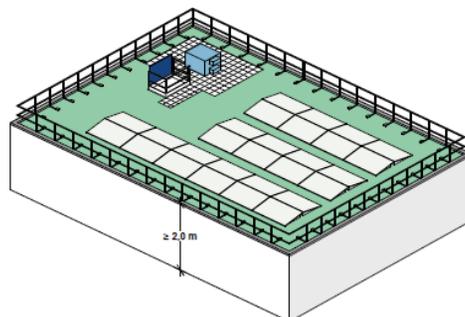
Classe d'équipement 3: protection collective à recommander pour les toits plats auxquels on doit accéder plusieurs fois par an pour de la maintenance ou d'autres travaux
